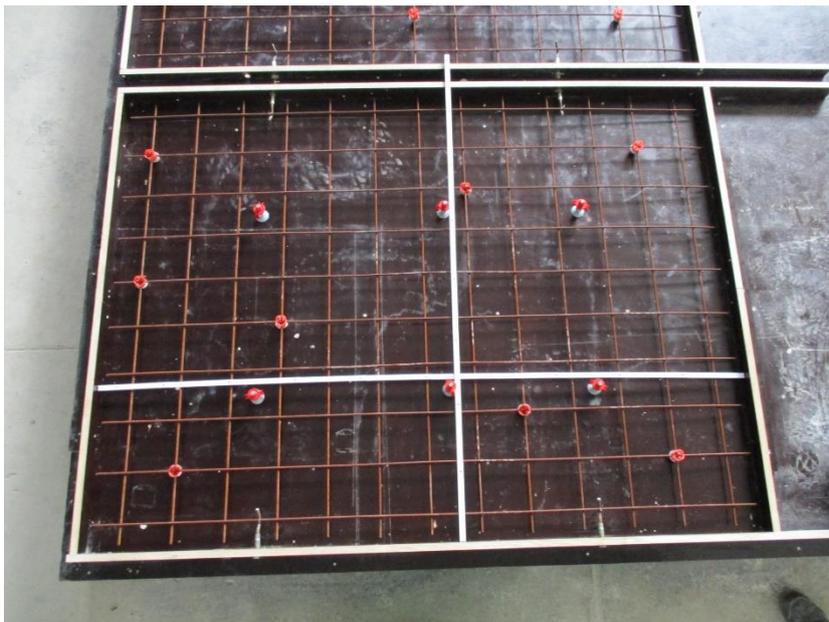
Schalung mit konstruktiver Bewehrung und Lage der Montagedübel
